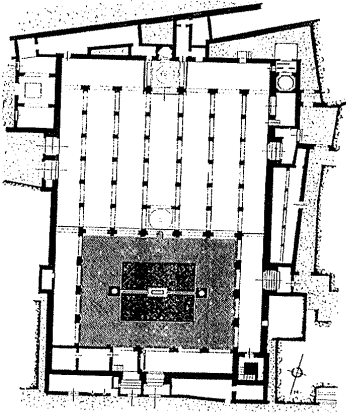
مسقط أفقي لمسجد سيدي بو مدين المربع بتلمسان.
